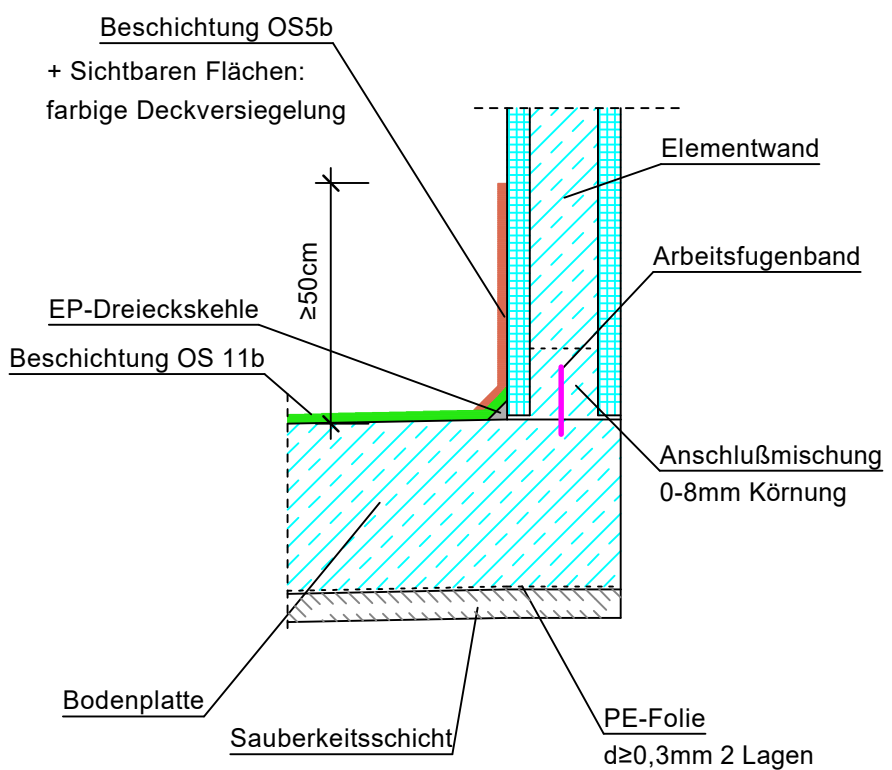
" Beschichtung Wandfuß in Bereichen mit Dämmung
